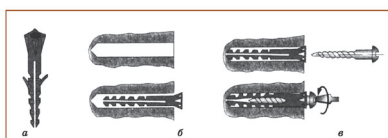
Внешний вид пластмассовой пробки (дубеля) (а); ее установка в отверстие (б) и завинчивание крепежного шурупа (в)
